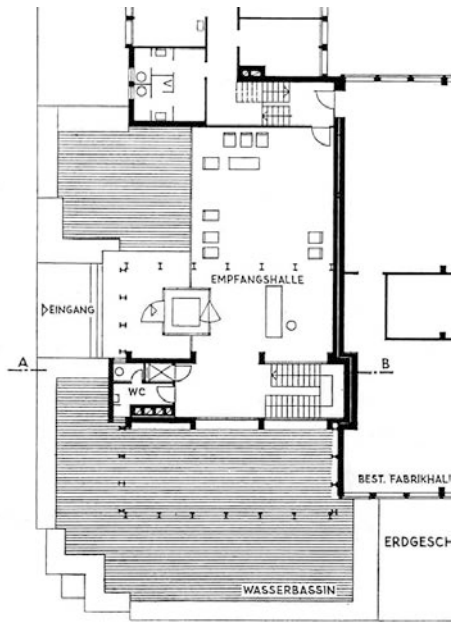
Bürohaus Grundriss EG mit Bassin. (SBZ, Heft 24, 1964)
